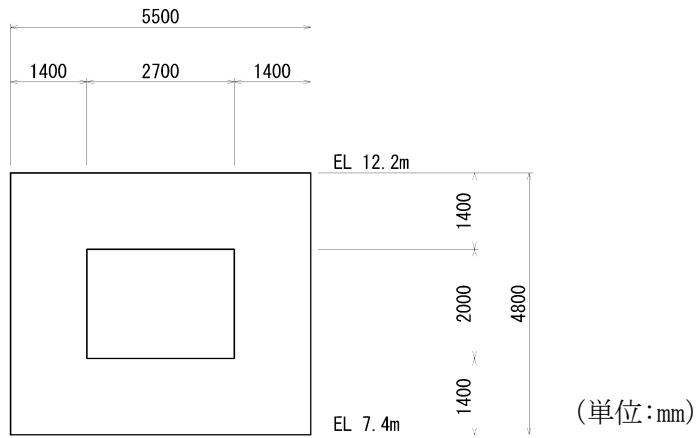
第 1 ベントフィルタ格納槽 断面図 (D-D断面)
